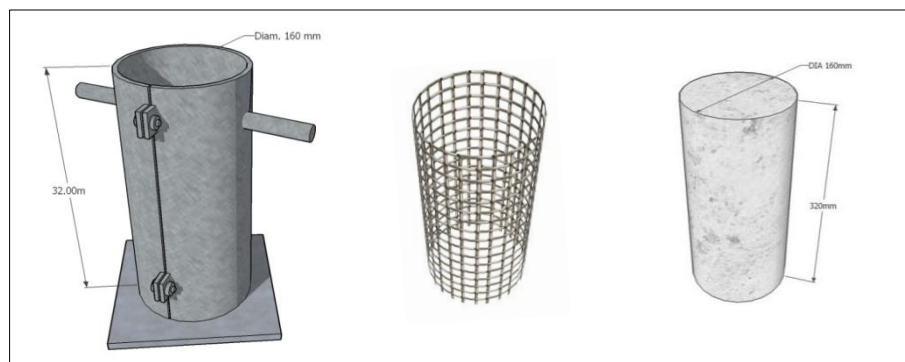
Moule / Spécimen, Grille et éprouvettes
